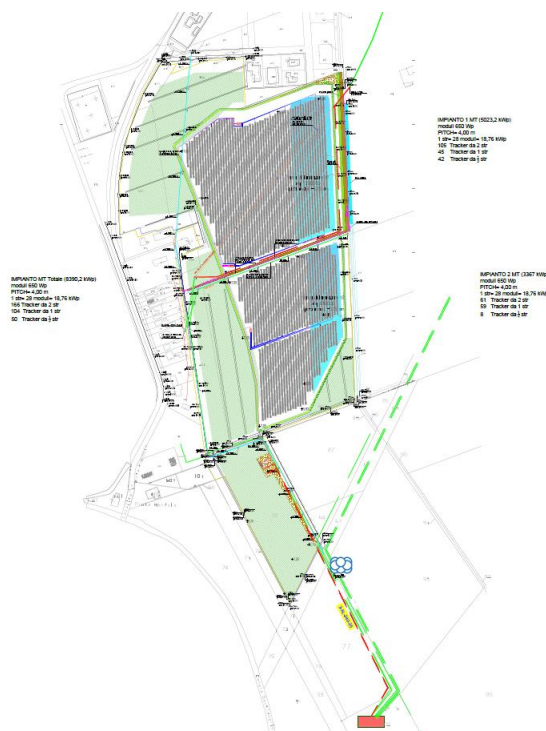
planimetria generale - Intervento Ariano nel Polesine
